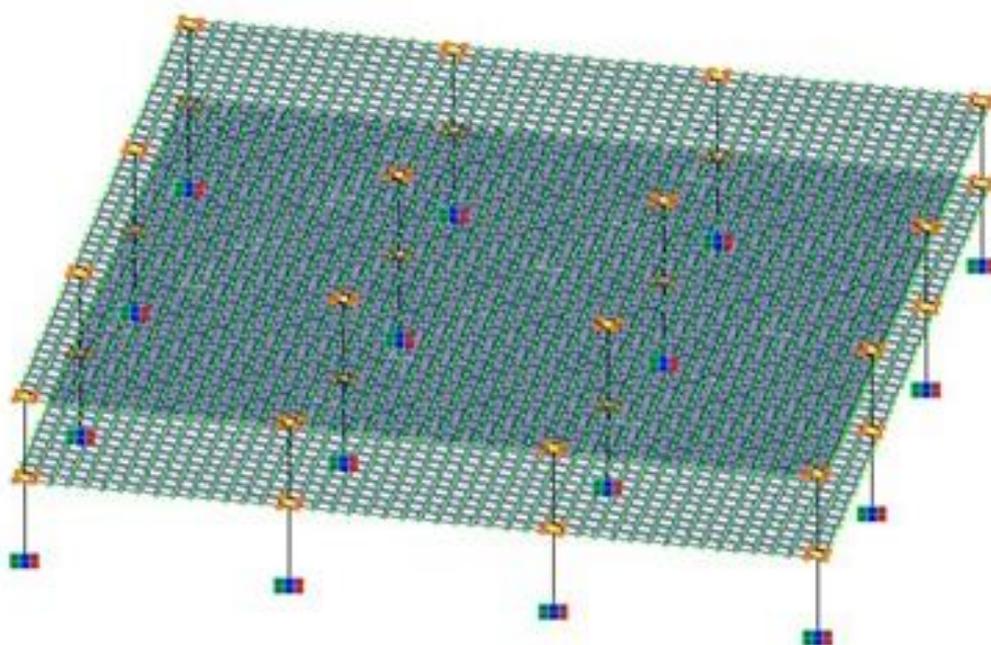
Расчетная модель безбалочного перекрытия
